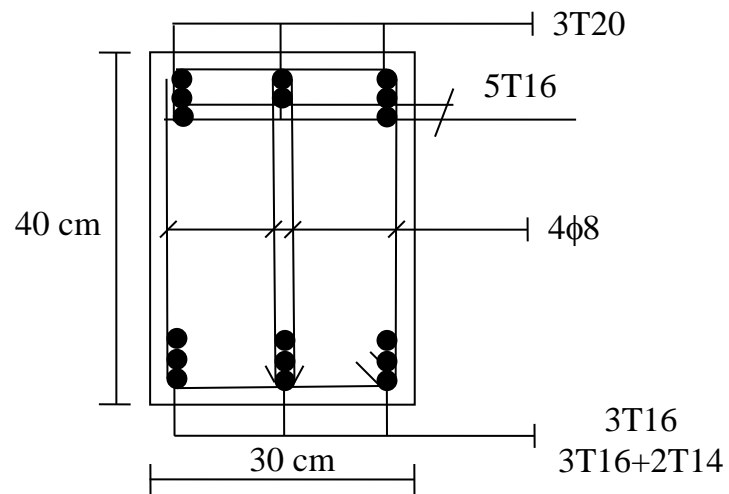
Schéma de ferrailage de la poutre Secondaire (Appuis)
